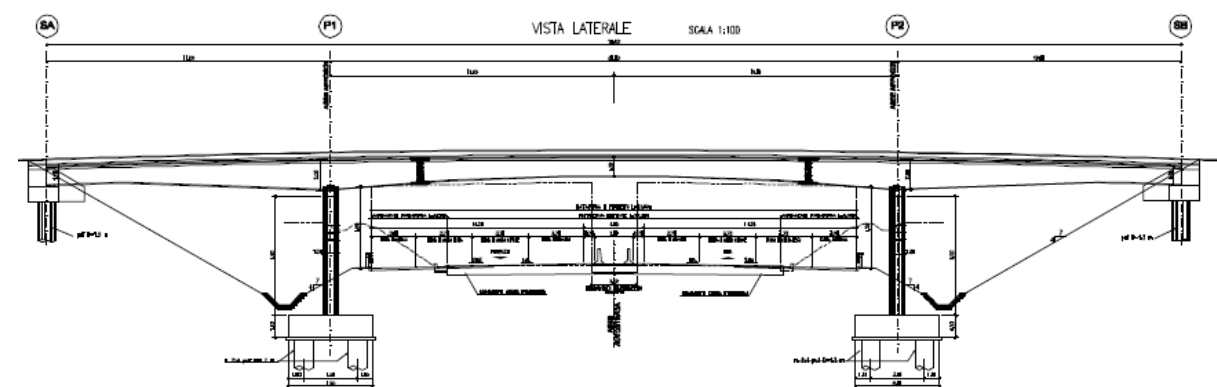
Sezione longitudinale cavalcavia a tre luci
